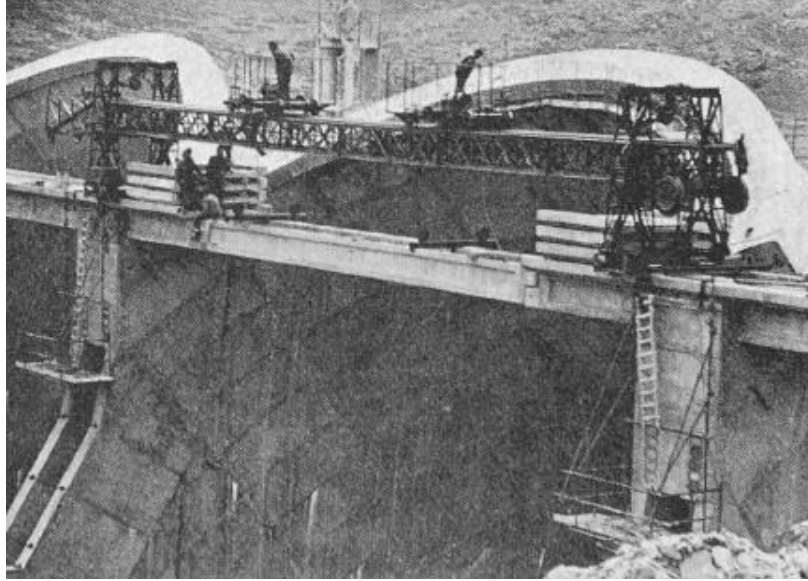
Mise en place d'une travée intermédiaire de la passerelle. On distingue, en attente, les éléments de dalles préfabriquées.
